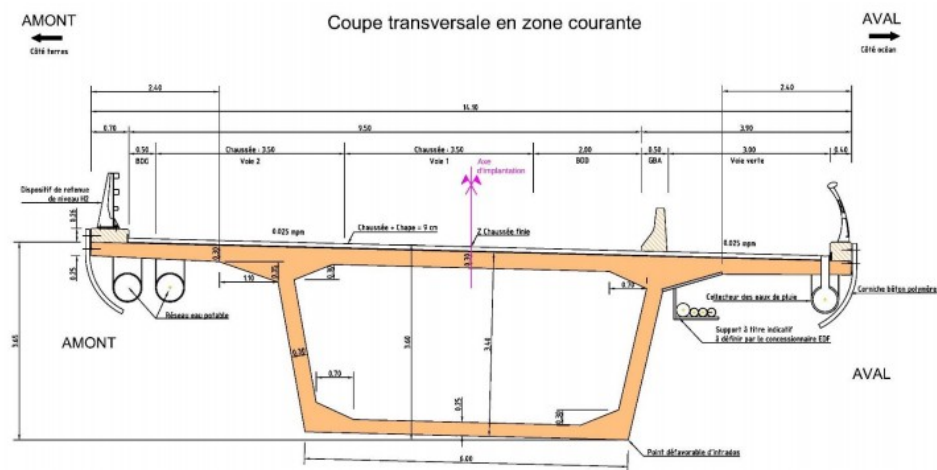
coupe transversale de la solution à hauteur constante (source : Cerema)
